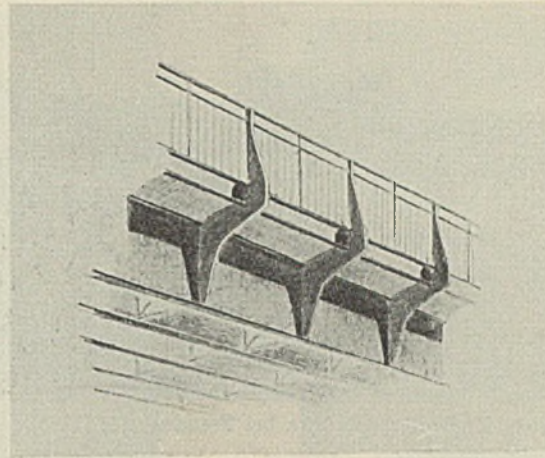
Reine Stahlbauweise. Konsole, Randträger und Geländer.
